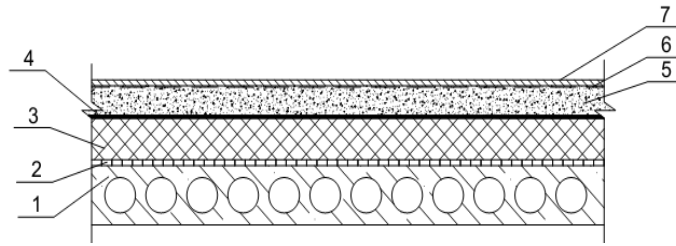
Конструктивне рішення щодо улаштування теплоізоляції перекриття з багатопустотних плит на стороні житлових приміщень першого поверху:
